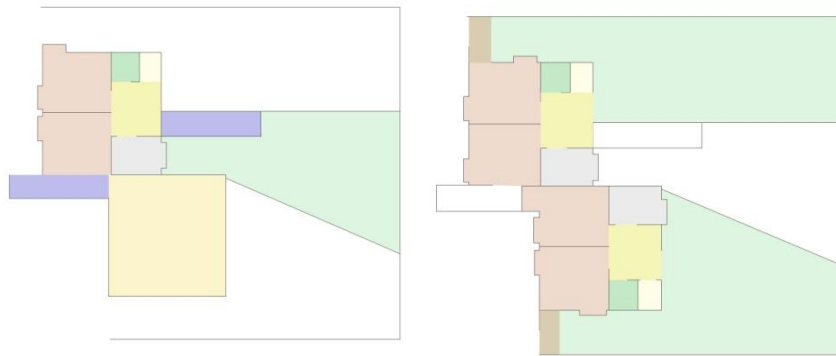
Planos de planta baja y primera planta. Malabar Cements
